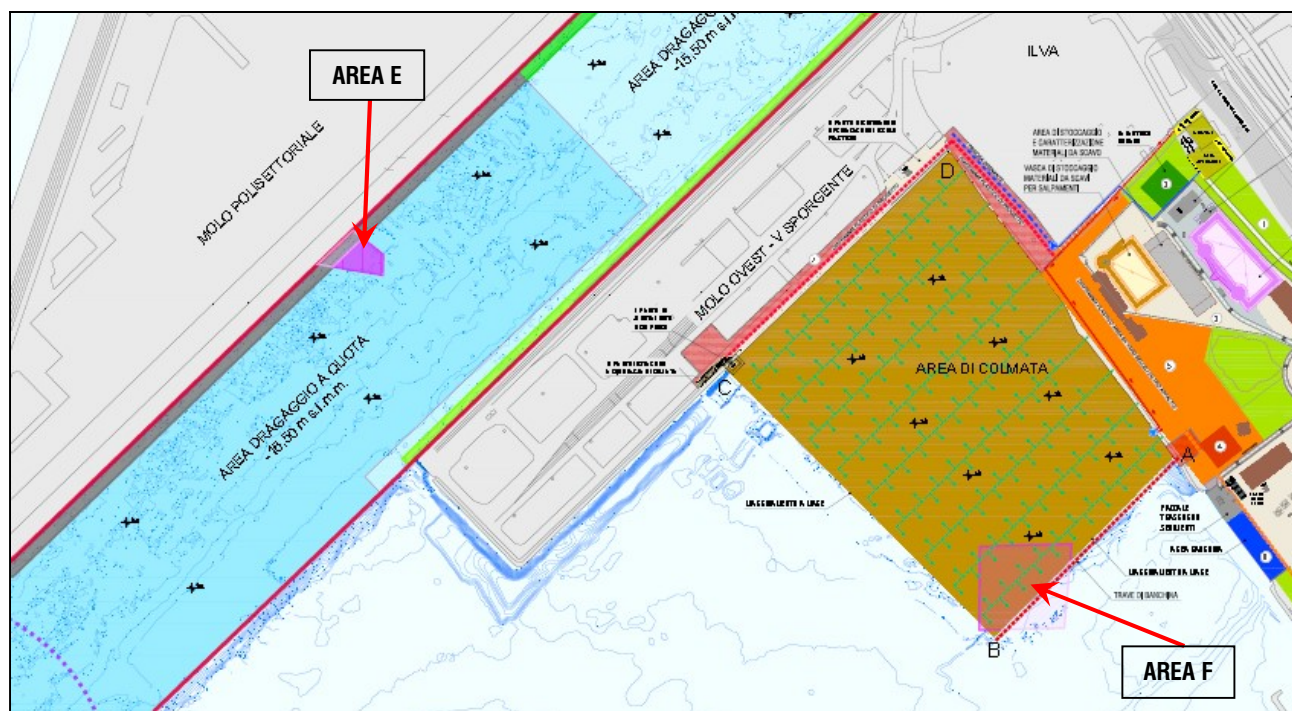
Stralcio planimetria generale interventi del Progetto Esecutivo.
